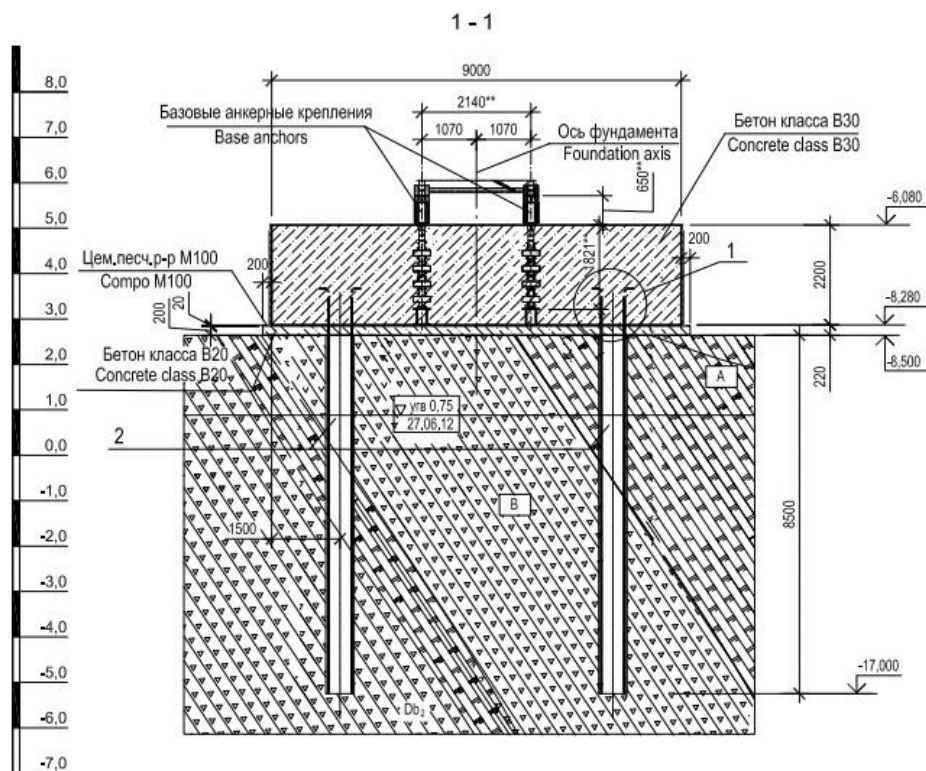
Схема устройства фундамента под башенные краны. А – зона интенсивного выветривания и разгрузки; В – зона разгрузки; 1 – арматура Ø28 – А 400; 2 – буронабивные сваи
